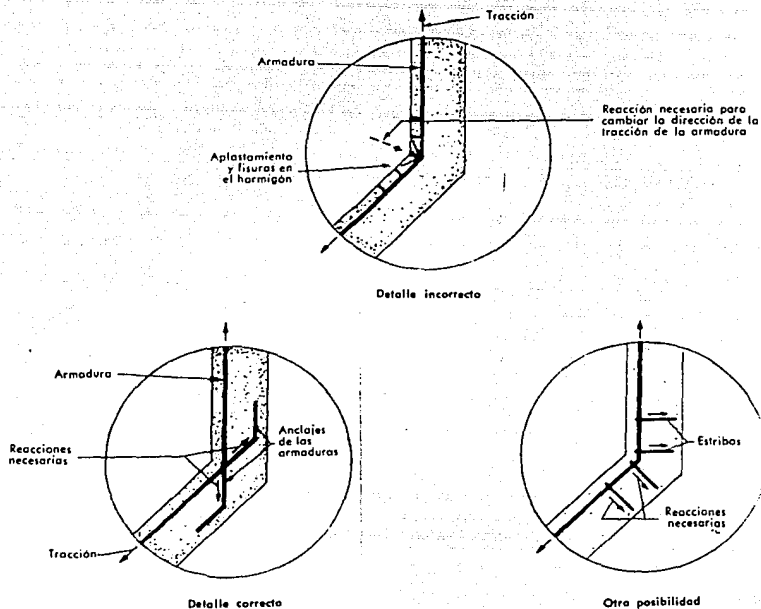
Causa del aplastamiento y fisuración de un ángulo entrante.
